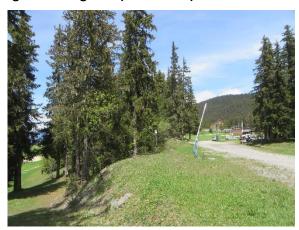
Coté est de la piste terrassée en graviers et gazon (vue du sud)
